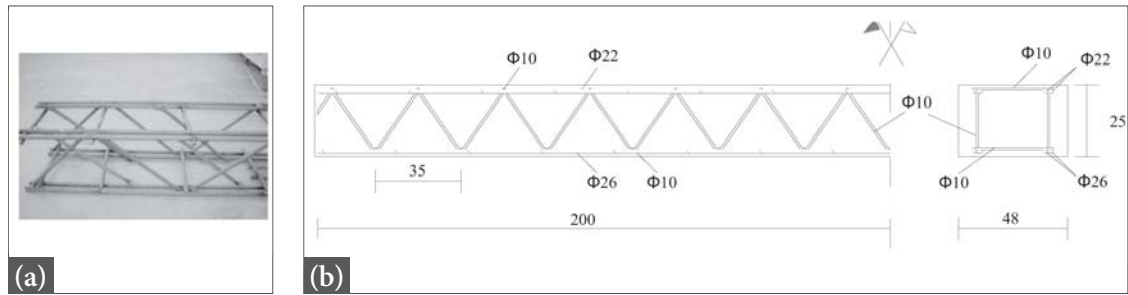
e 1b – Schema delle Travi PREM senza fondello inferiore (Foto + disegno).
